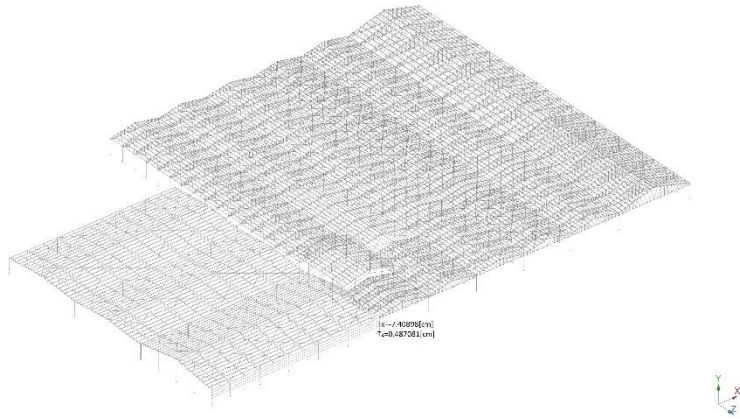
Desplazamientos Verticales Actuantes en Estructura Nave 1
